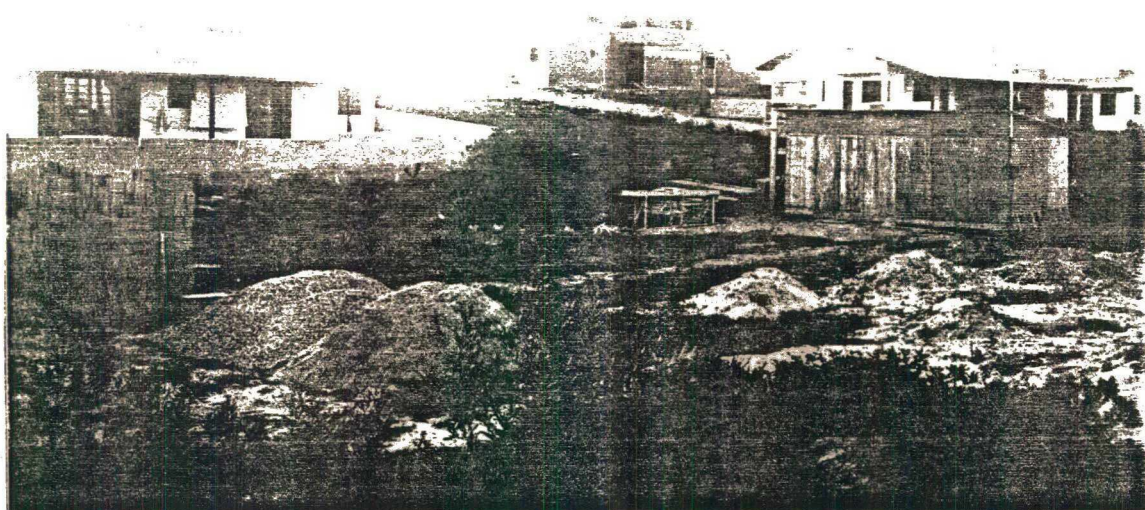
Tipo de construções no Condomínio Praia do Santinho
